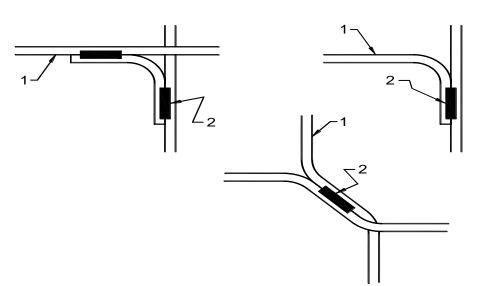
Uniones de soldadura de varillas de refuerzo o de concreto reforzado (si es permitido)
